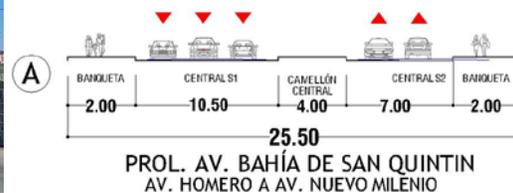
Av. Homero y su sección vial actual y propuesta. Fuente PDU 2040.
